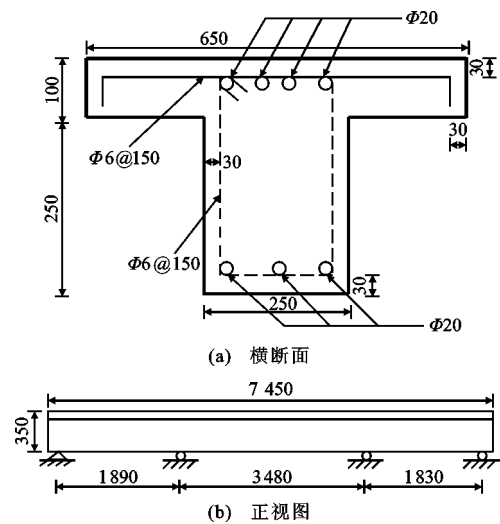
钢筋混凝土三跨连续梁构造(单位:mm)
